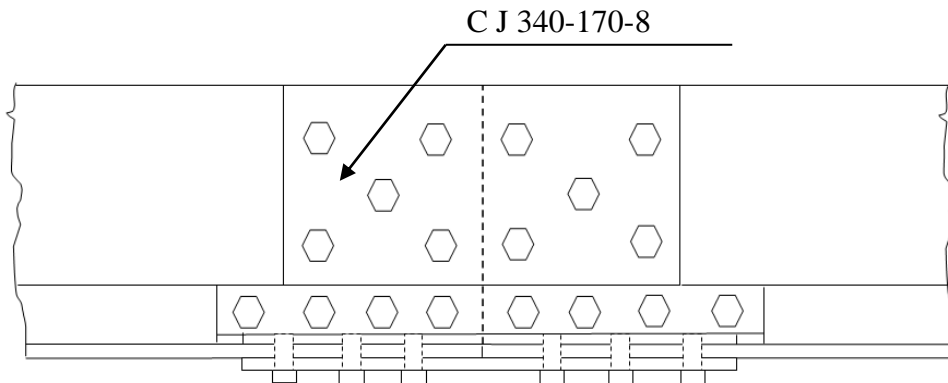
Assemblage bout à bout par couvre joint (vu de face).
